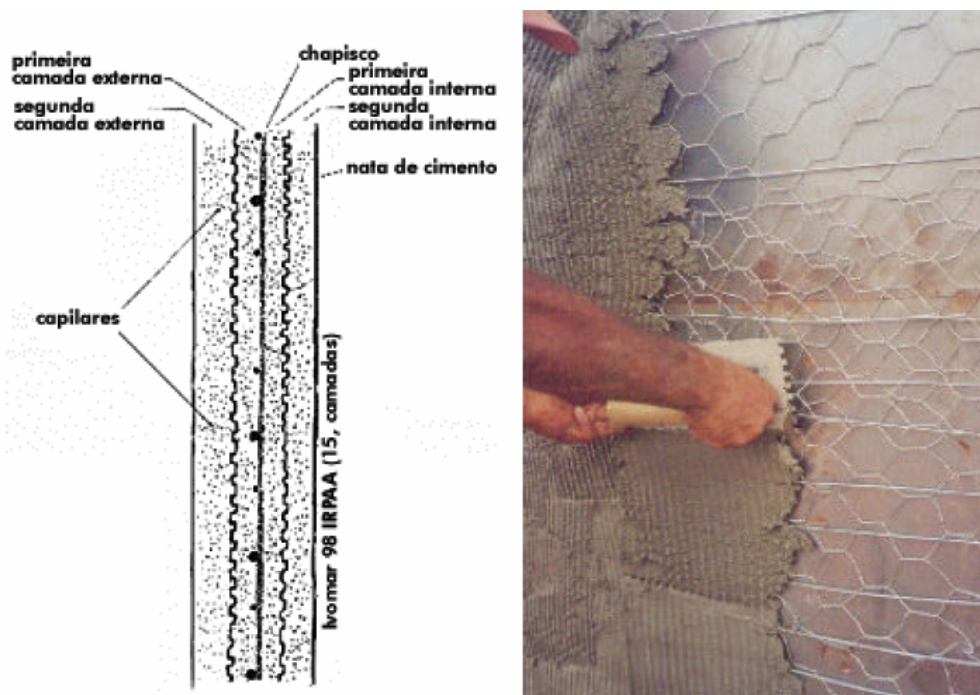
a) Corte vertical da parede do reservatório; b) Aplicação da primeira camada
